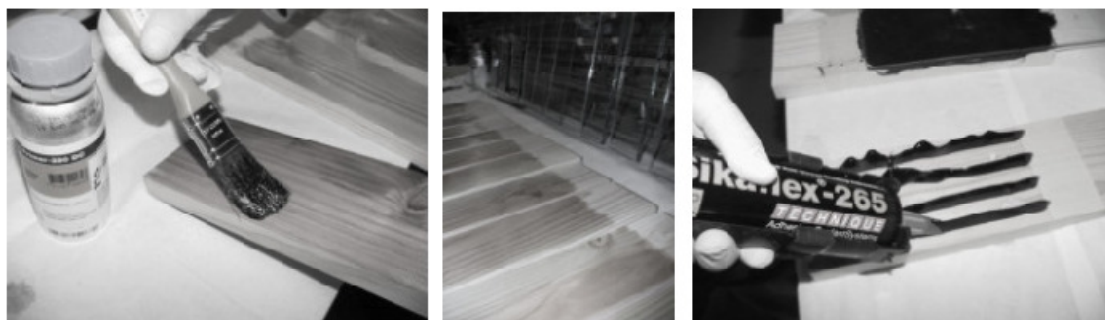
Exemplos da aplicação de primário nos provetes⁽³⁴⁾
